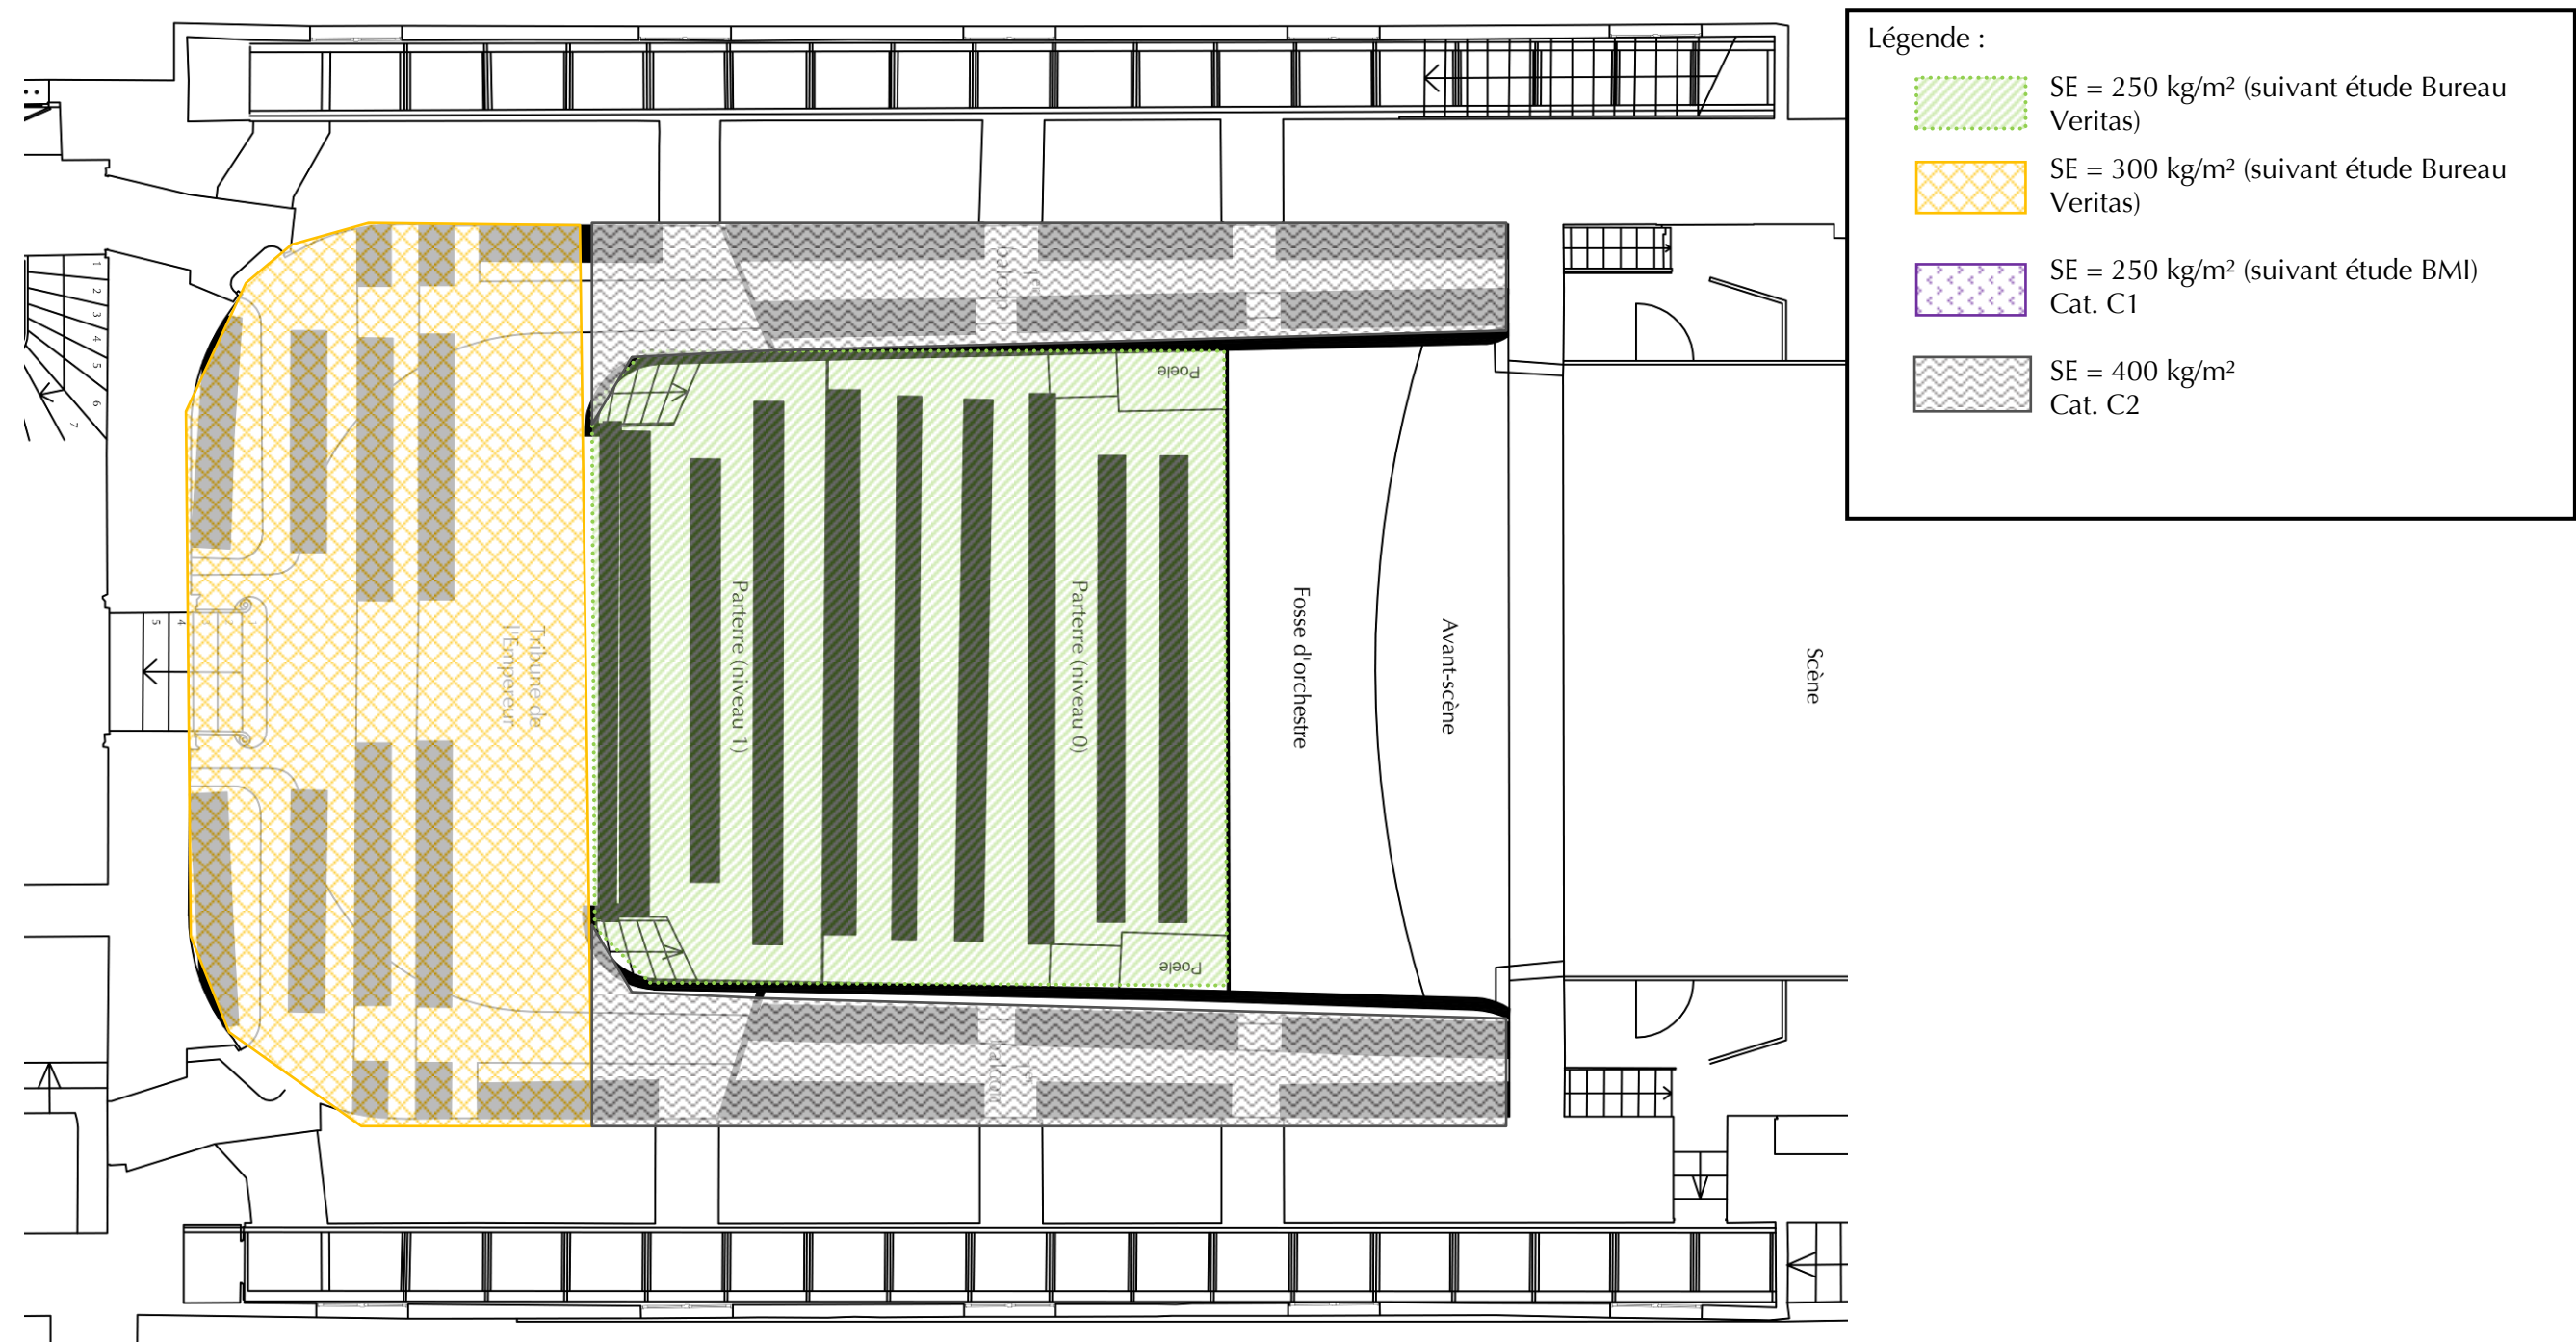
Plan rez-de-chaussée – Cartographie des surcharges d'exploitation
